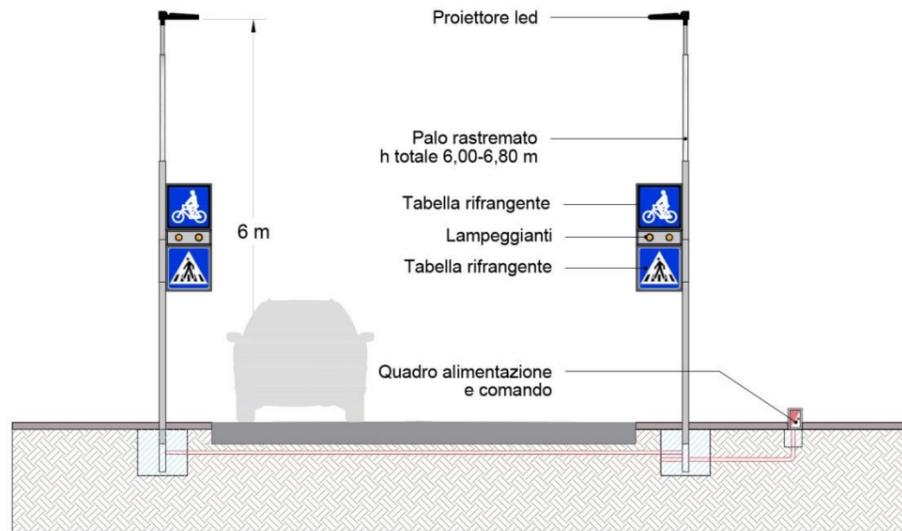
Planimetria e sezione del sistema di segnalazione e illuminazione degli attraversamenti
